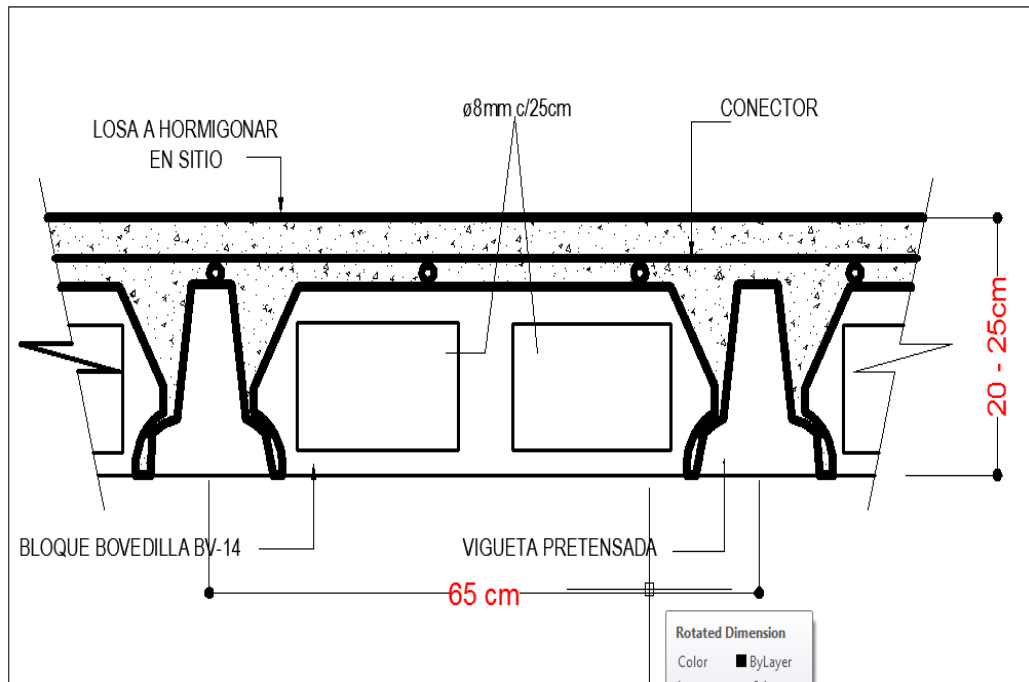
Losas con vigas viprek y bloques bovedillas.
